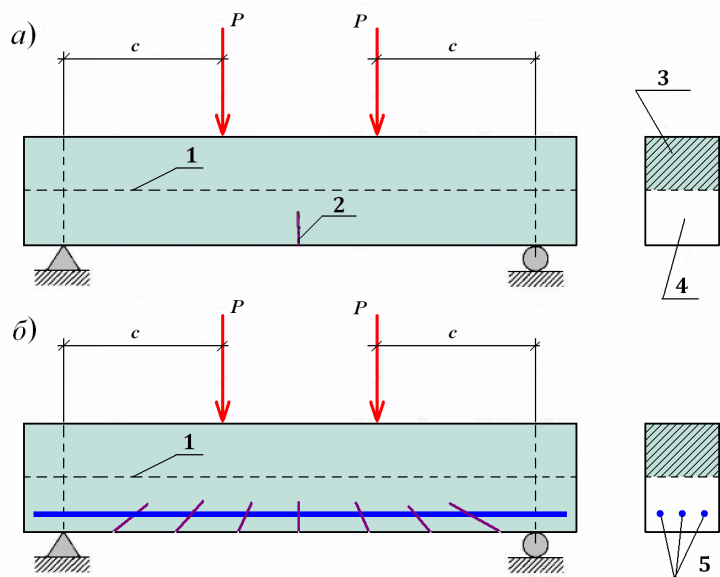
Схемы разрушения балок: а) - бетонная балка; б) - железобетонная балка; 1 - нейтральная ось; 2 - трещины; 3 - сжатая зона; 4 - растянутая зона; 5 - стальные стержни (арматура)
